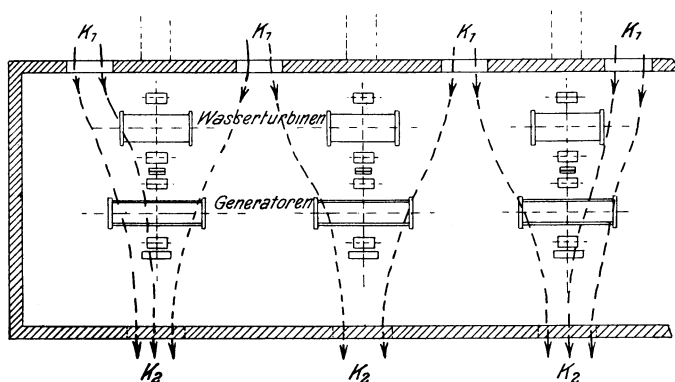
Luftführung innerhalb eines Maschinensaales.
